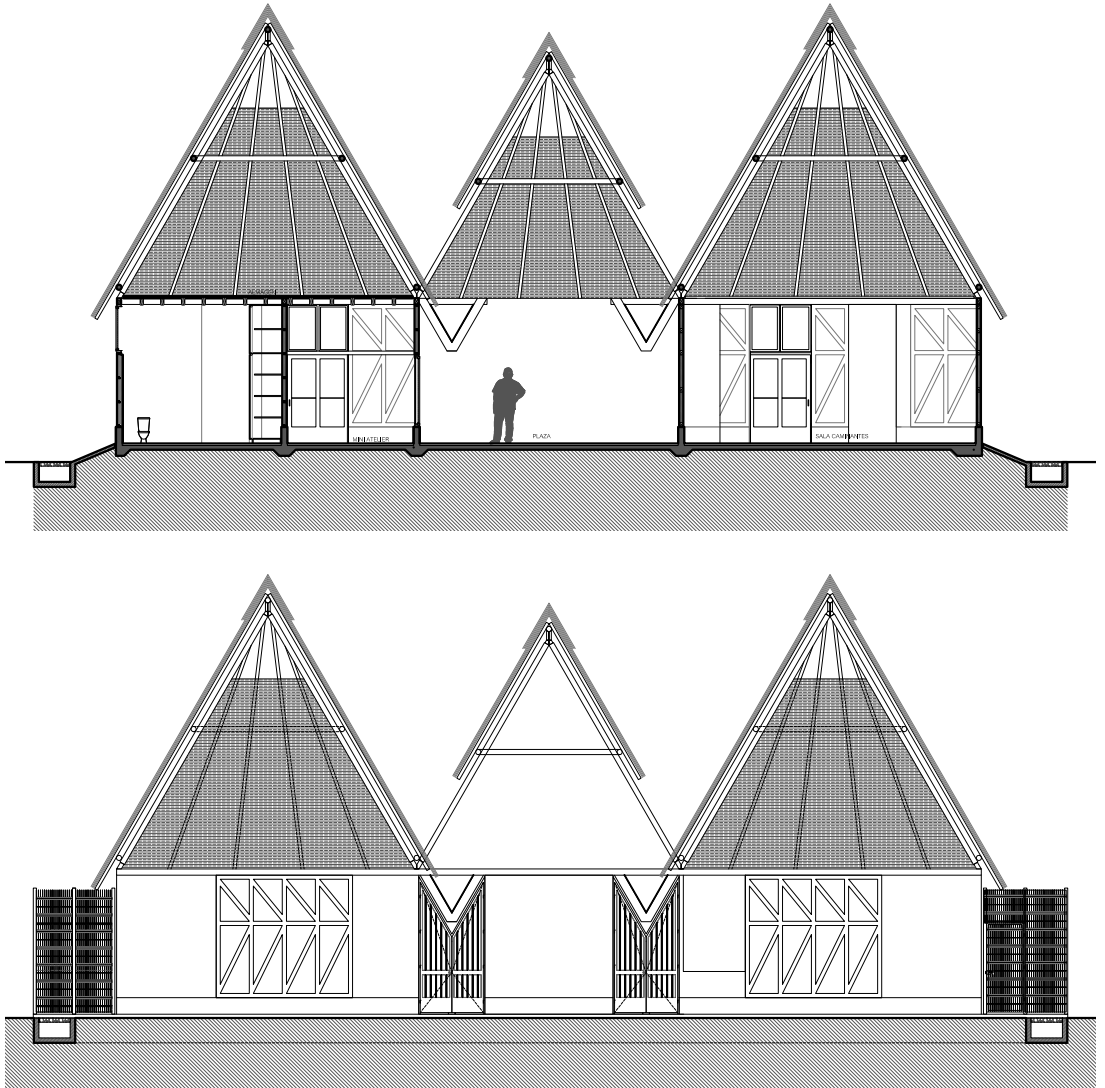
Sección transversal y elevación hacia la calle del CIAI Cuna Más.
